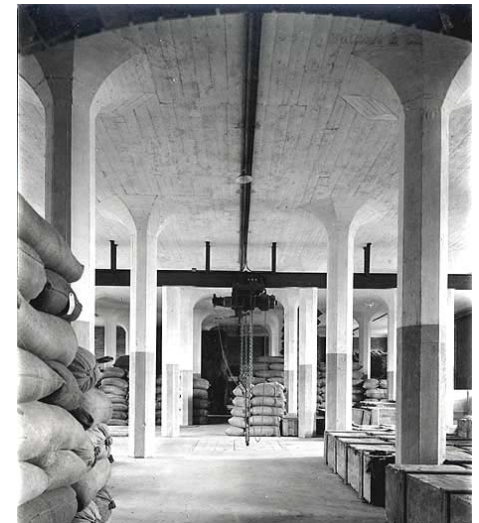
| Pilzdecke Lagerhaus in Zürich Giesshübel 1910 - R.Maillart
